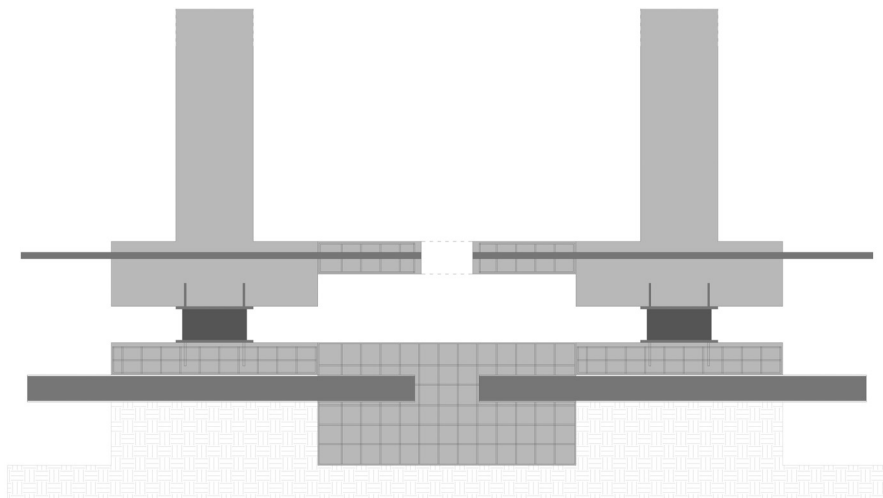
43 – Posa dell'armatura e getto di completamento della prima platea di fondazione
